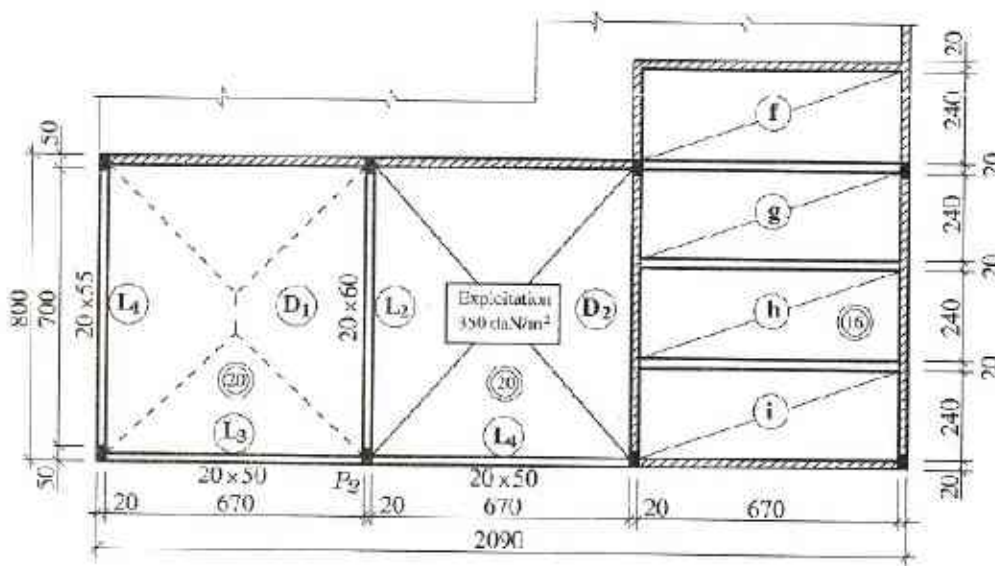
Plan de coffrage, plancher haut du rez-de-chaussée
